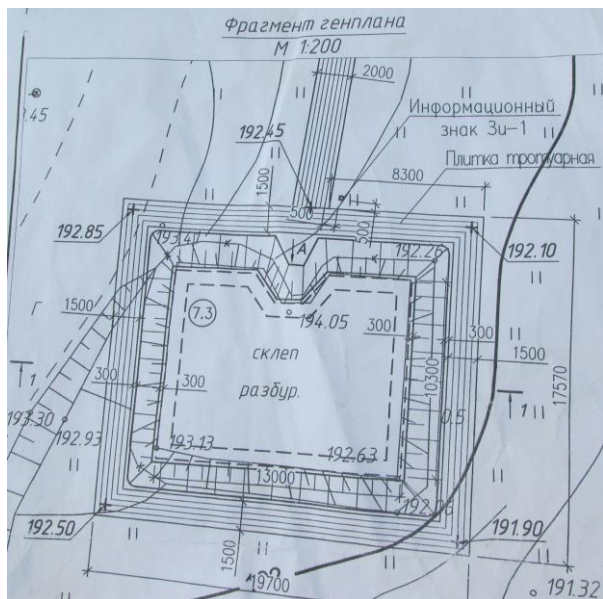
Фундаменты усадебного дома («склепа») на генеральном плане
